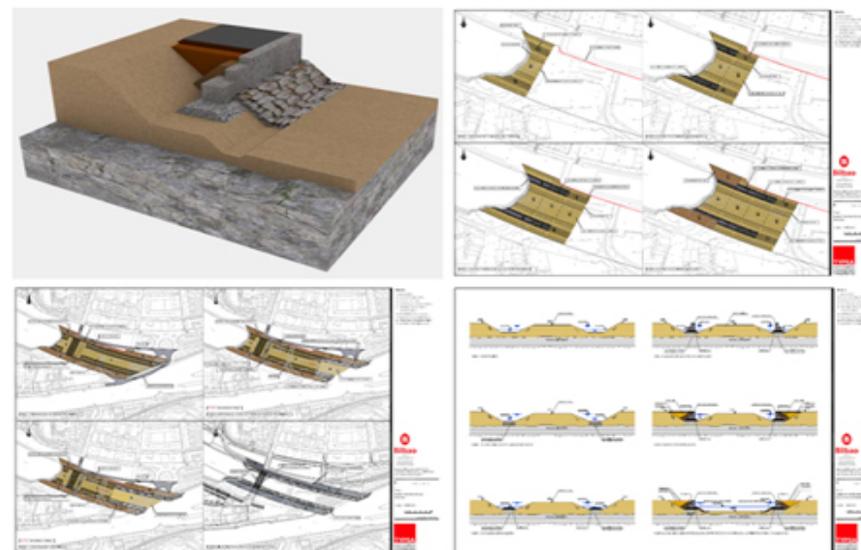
D de la sección tipo propuesta y planos del proceso constructivo planteado, teniendo en cuenta la compatibilidad con la ejecución del puente de acceso a la isla de Zorrozaurre
